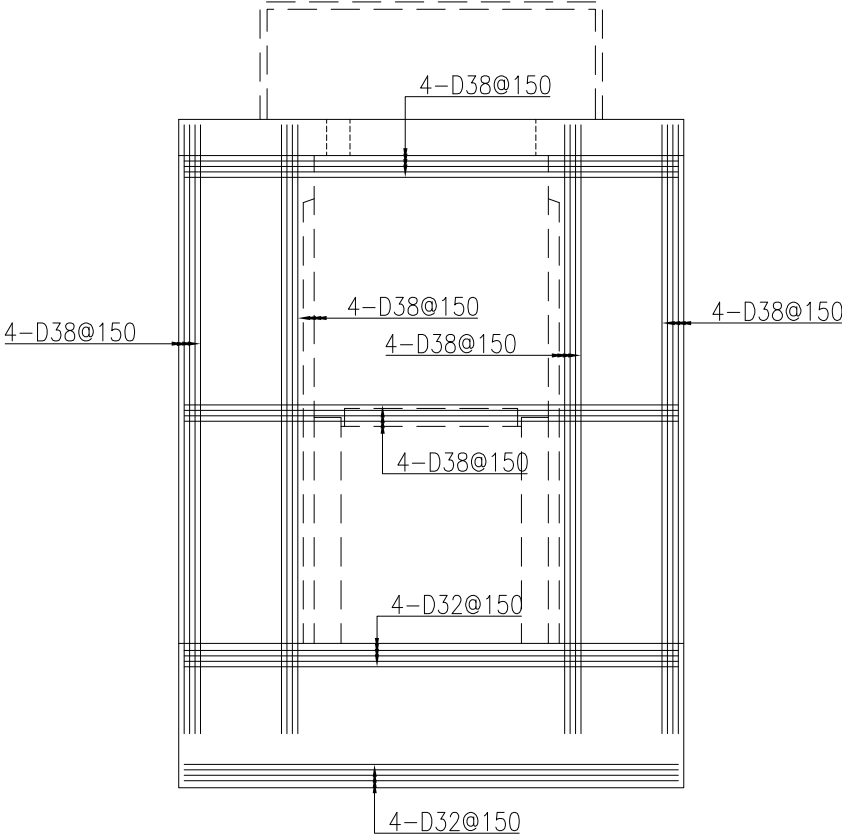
(2) 概略配筋图 (B-B 断面)
